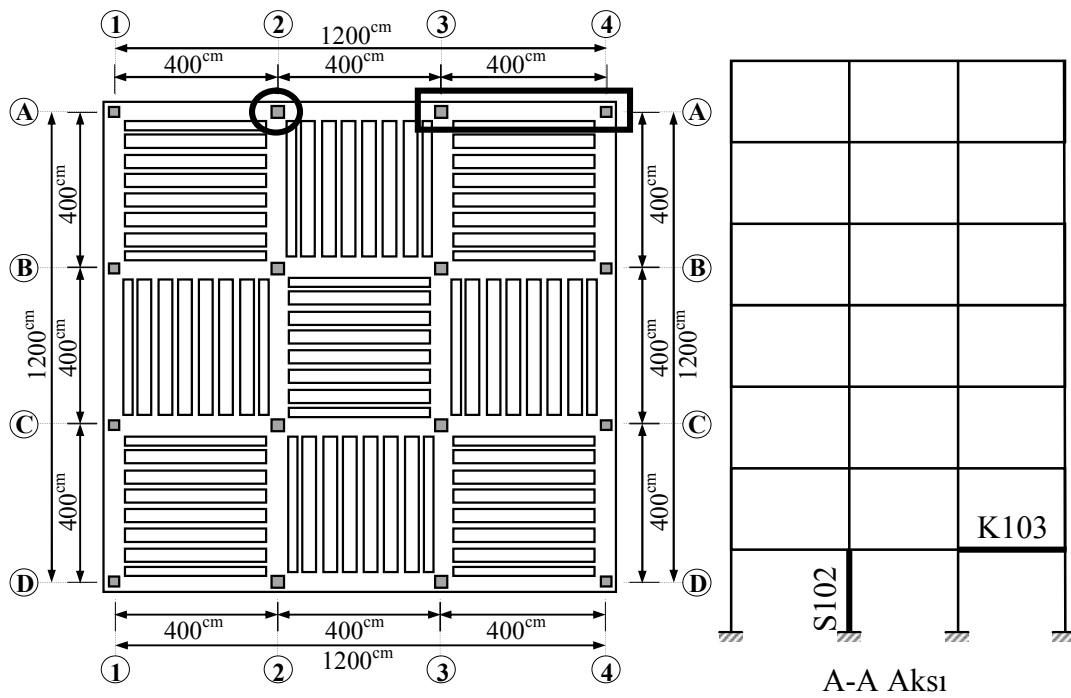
7KÇB'de Tipik Kiriş Detayı
